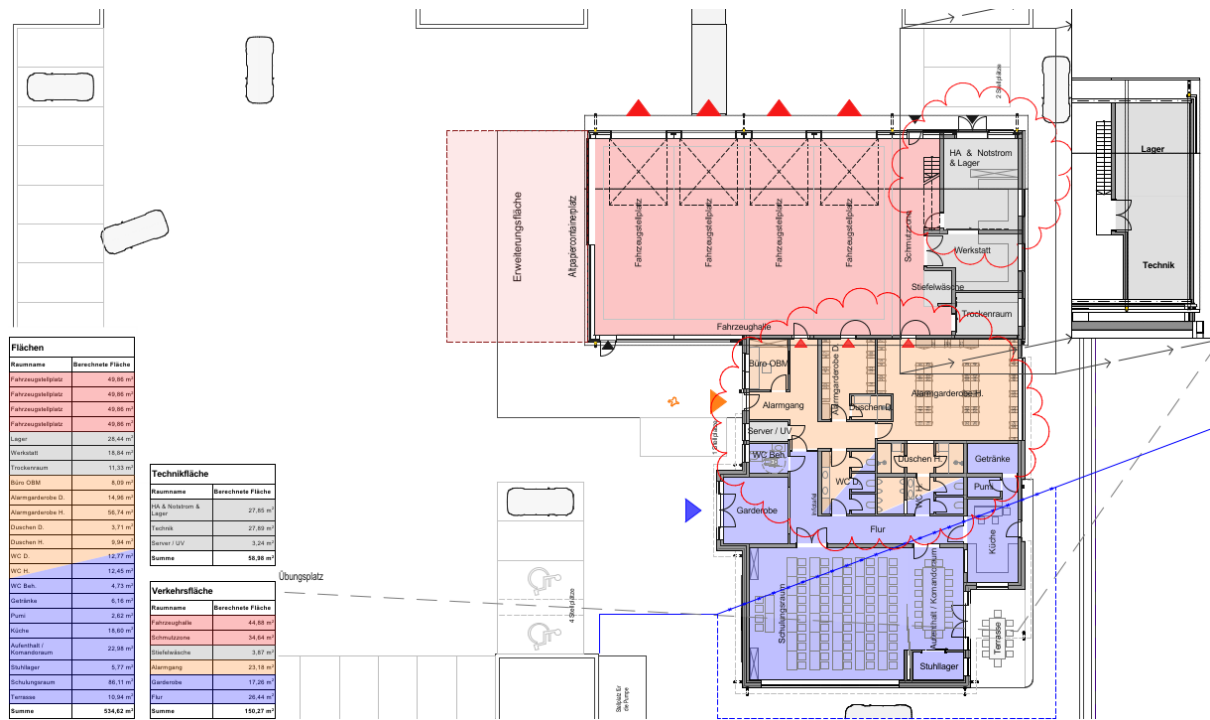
Grundriss mit Nutzungszuweisung
